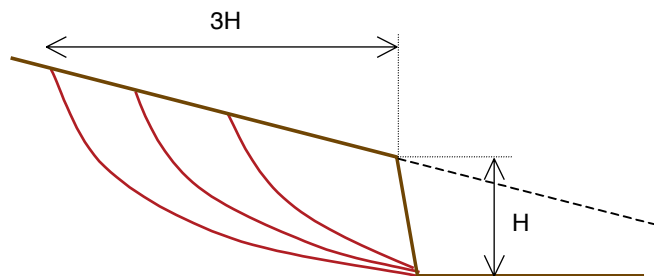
Application de la règle des « 3H » : cas d'un déblai.
